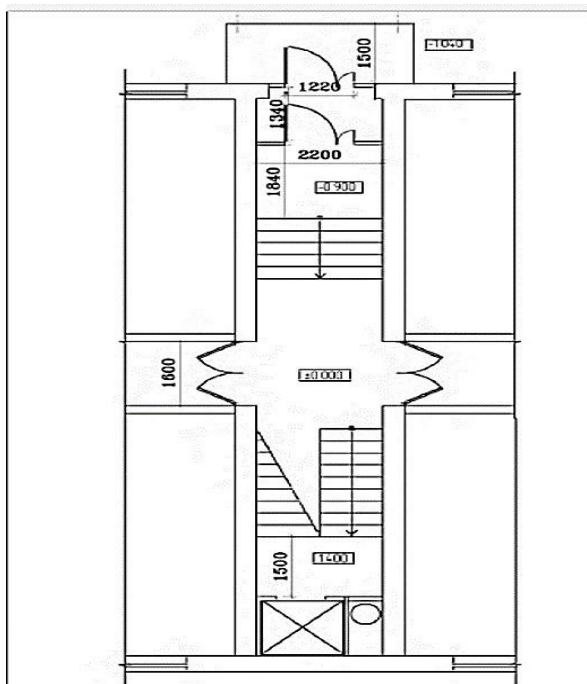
Планировка вестибюля с лифтом на межэтажной площадке
